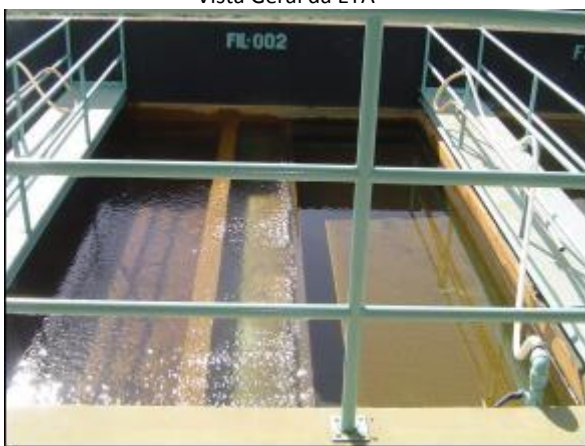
Fotos de ETA de Dupla Filtração Construída em Chapa Metálica (DI BERNARDO E SABOGAL PAZ, 2008)
